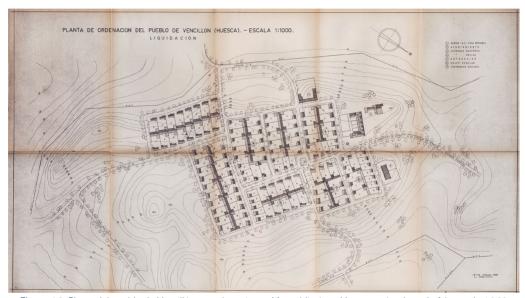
Planta del pueblo de Vencillón, por el arquitecto Manuel Jiménez Varea, según plano de febrero de 1968 (Fuente: AHL, Lérida).
